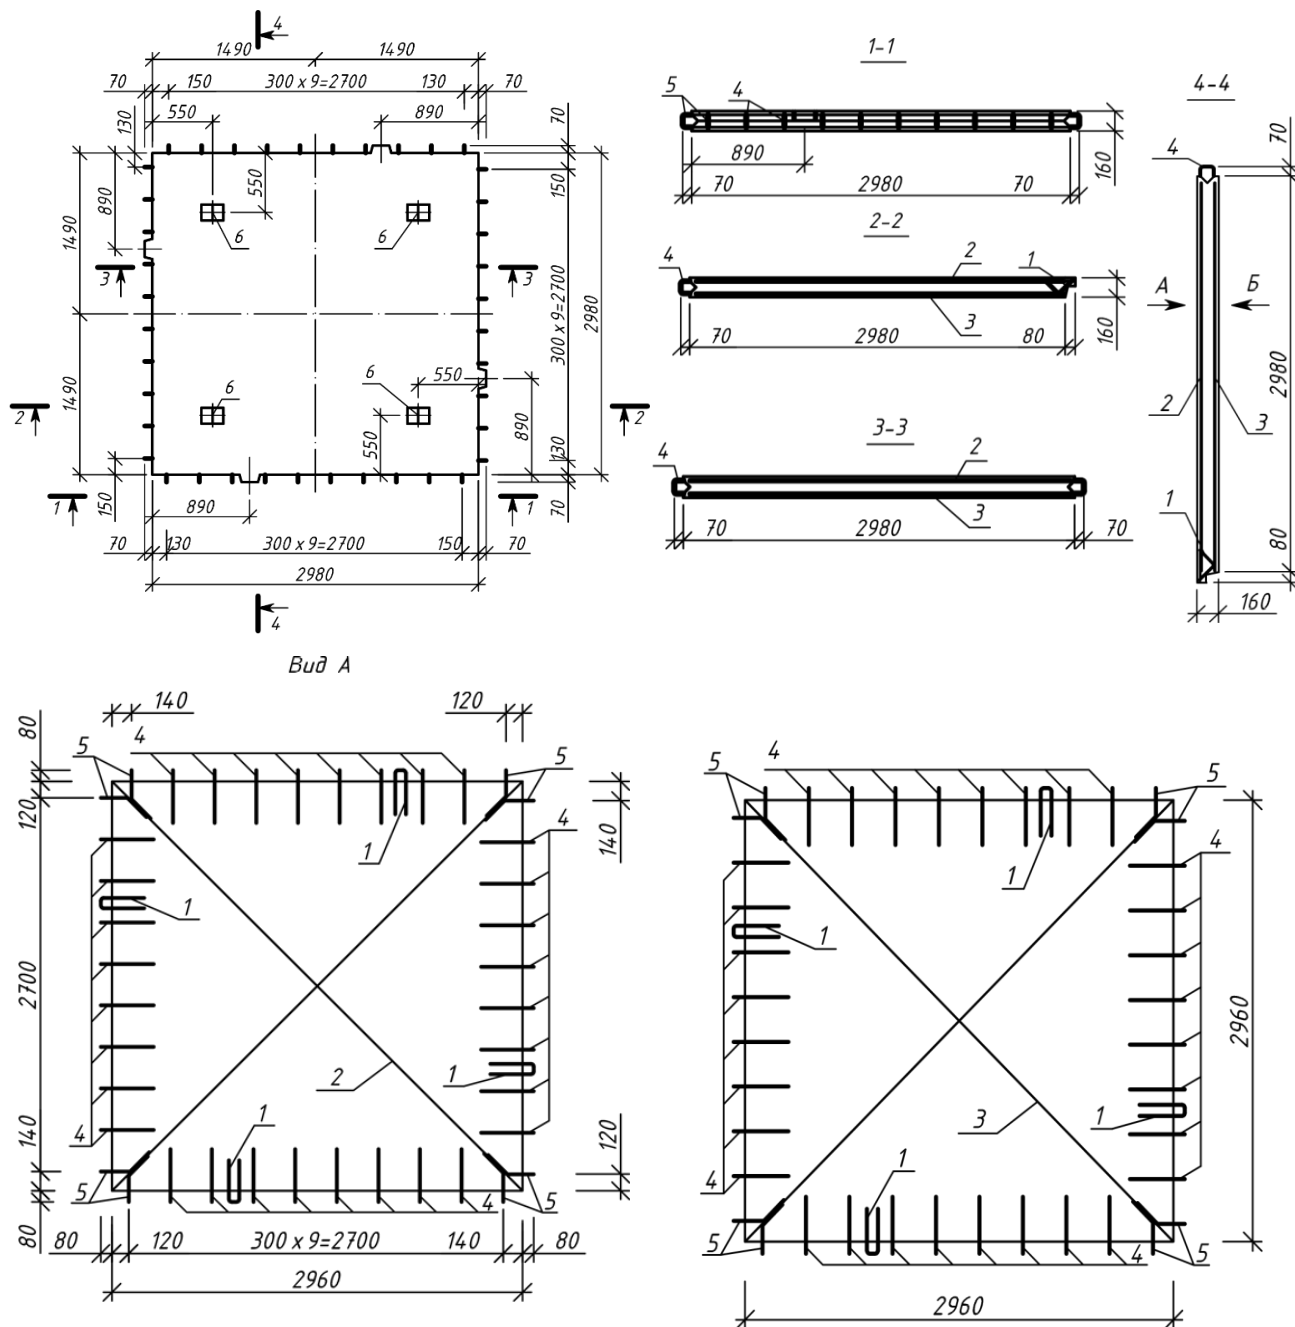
Опалубкове креслення та схема армування середньої плити ПС 30.30.1,6-2-3
